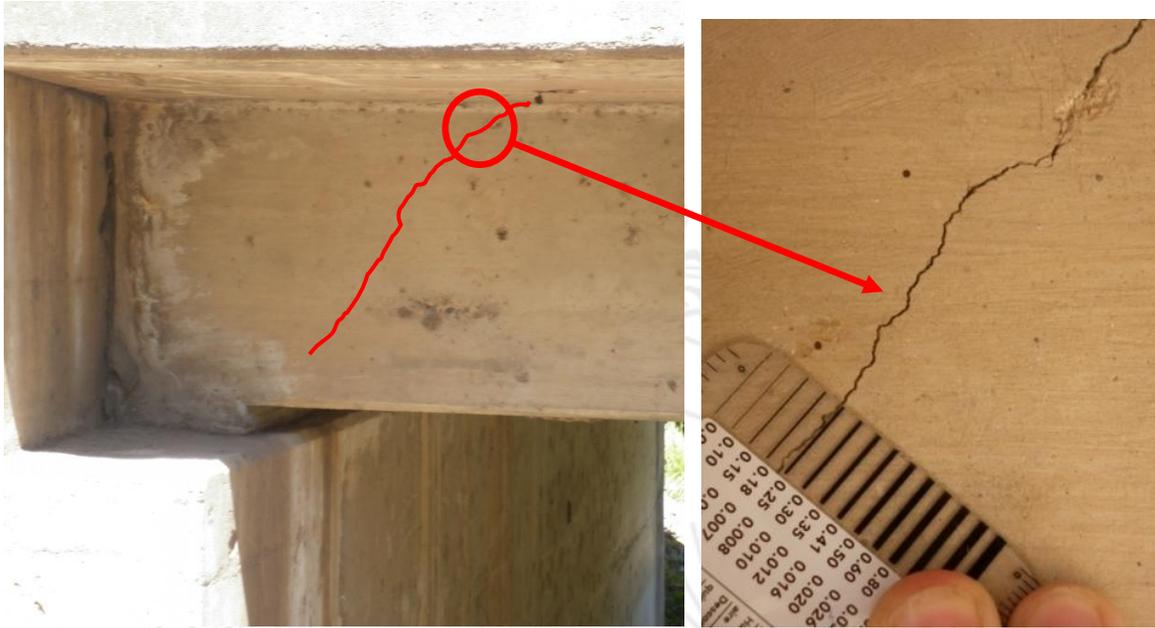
Grietas por cortante en las losas. (típico)
